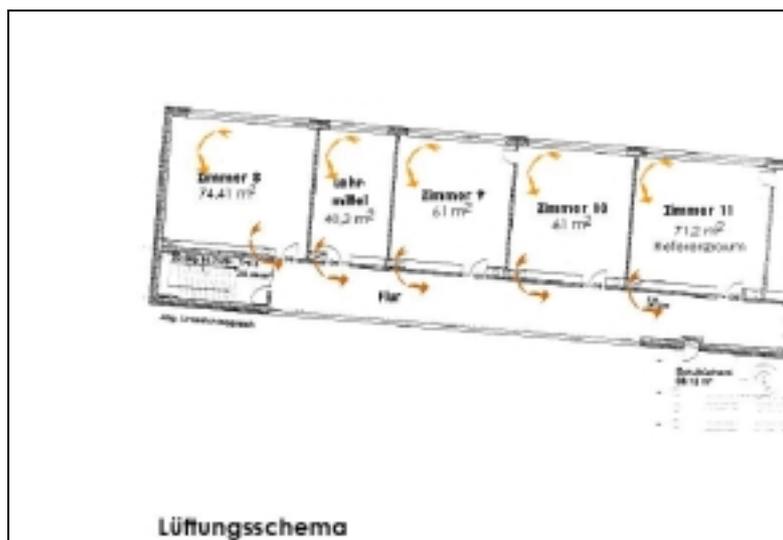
Lüftungsschema im Grundriss der Justus von Liebig Schule Waldshut
